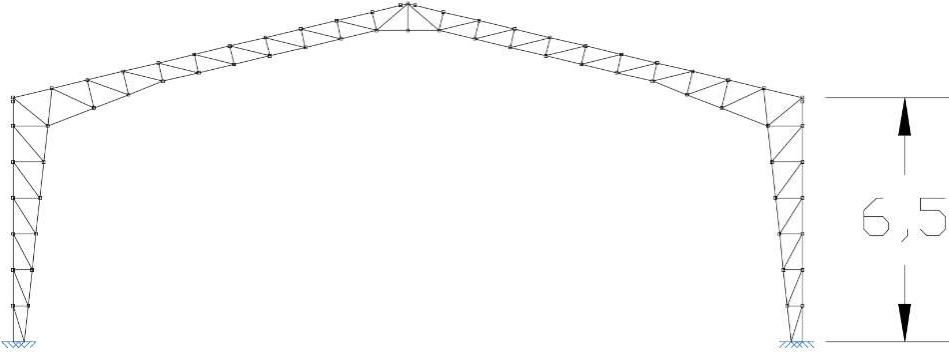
Vista 2D del pórtico base de la nave industrial, con la altura de columna acotada
